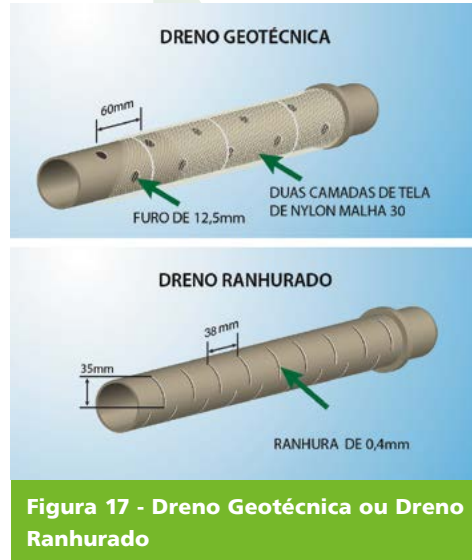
Dreno Geotécnica ou Dreno Ranhurado
